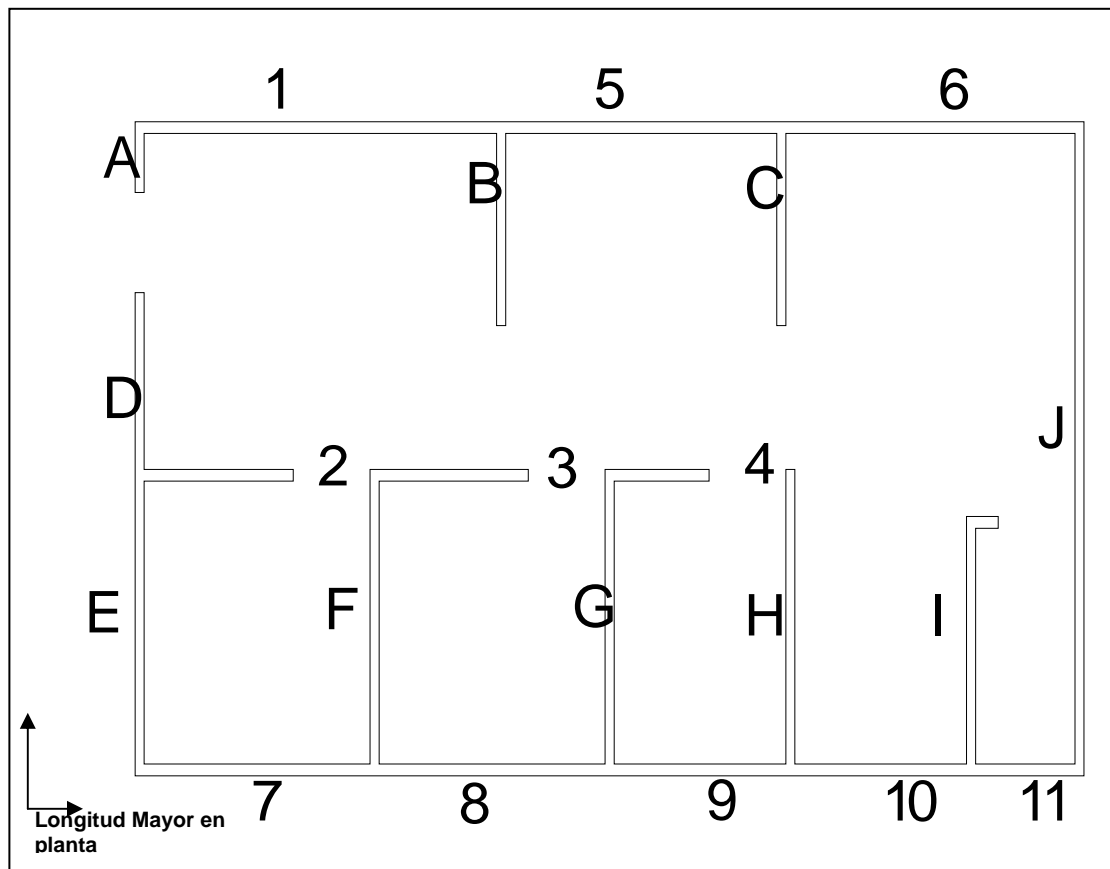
PLANO UNO EN PLANTA CASA DE UN PISO
